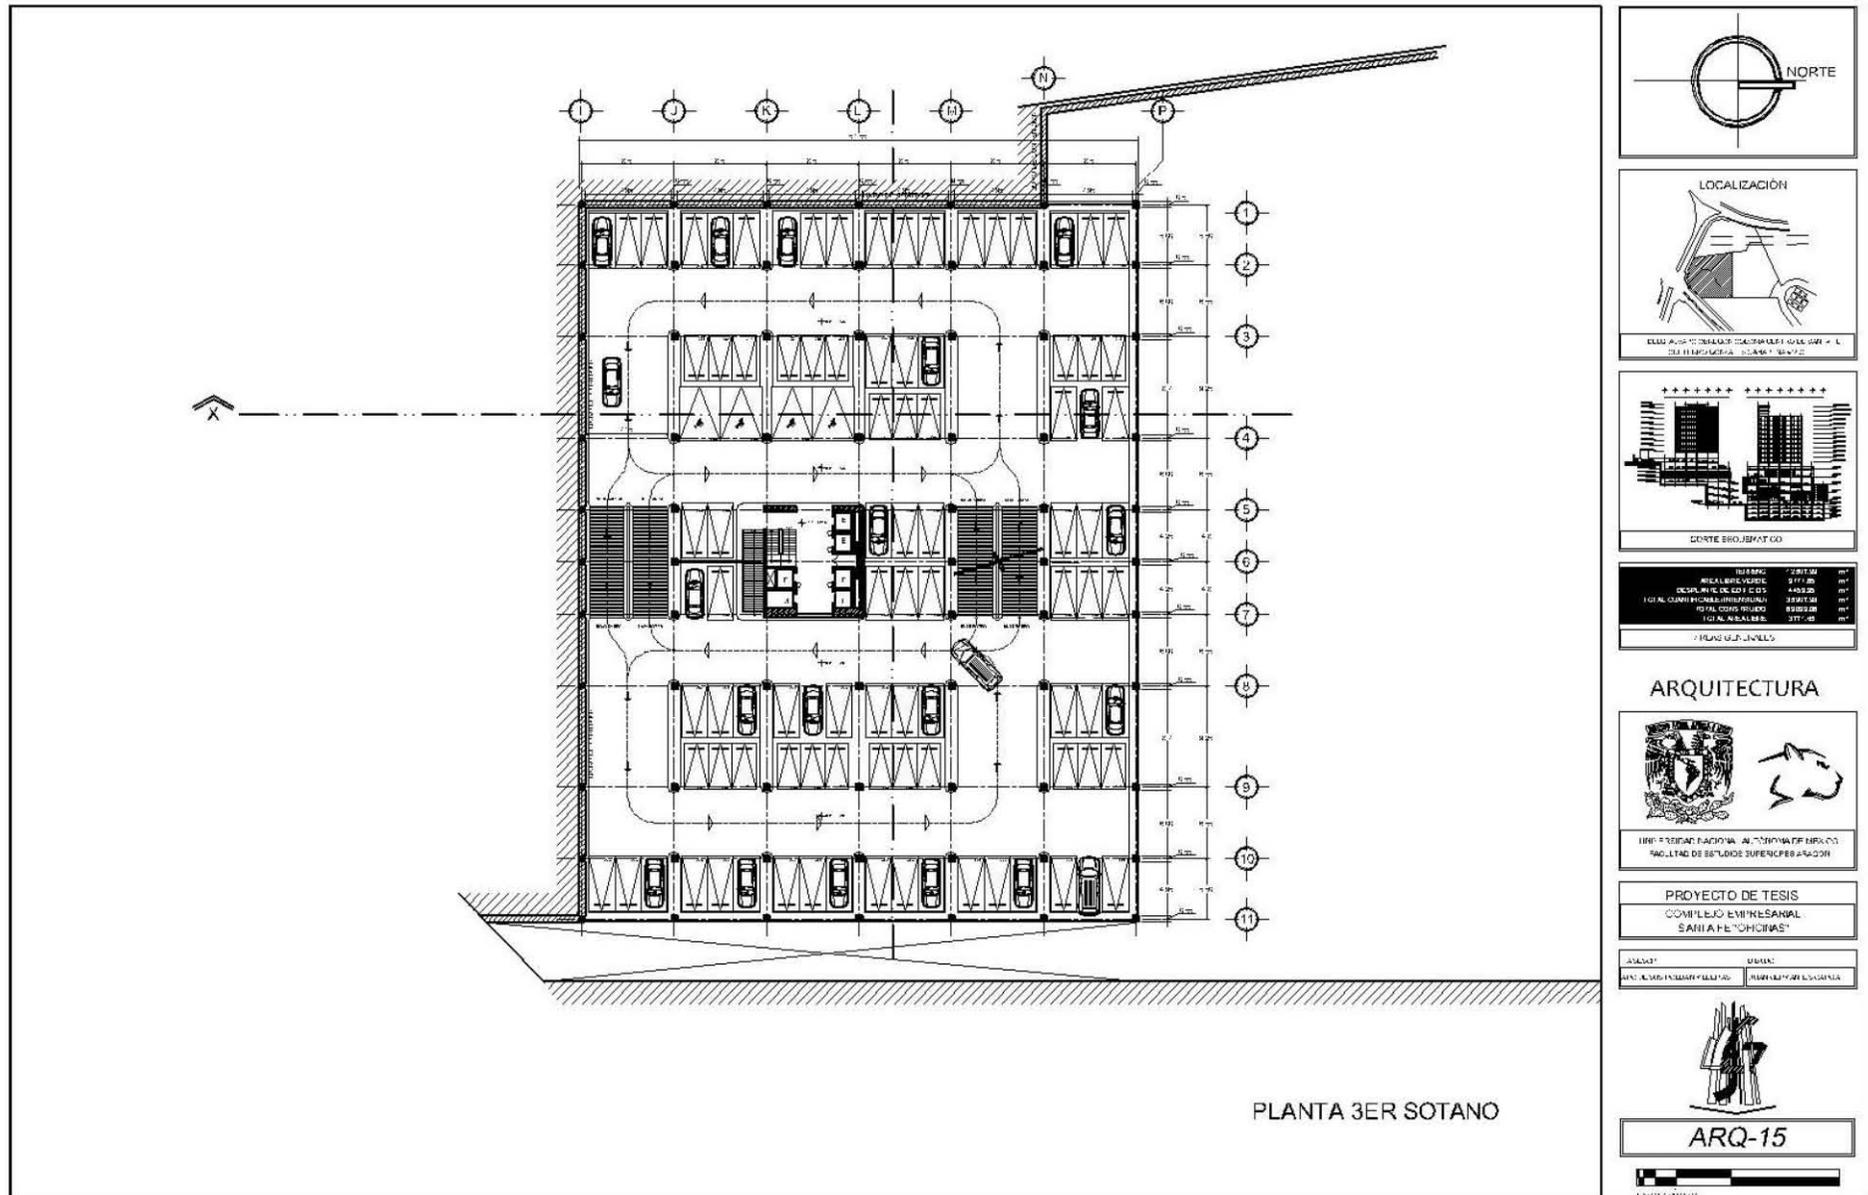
Plano ARQ-15; Planta Sótano 3 Oficinas. Edición propia.
